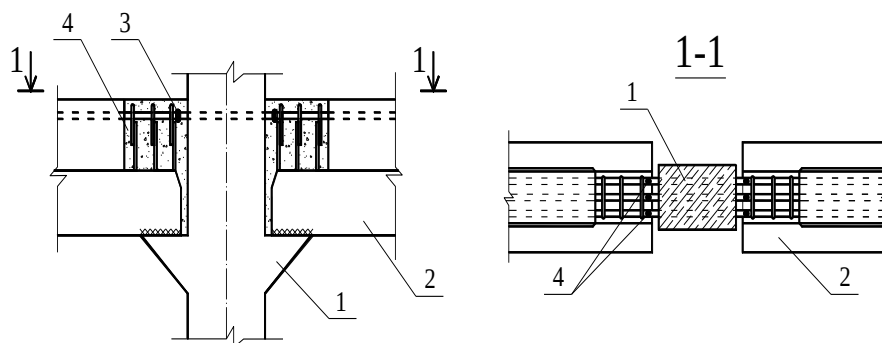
Сопряжение сборных поперечных ригелей перекрытия с колонной: 1 – колонна; 2 – ригель; 3 – ванная сварка; 4 – бетон замоноличивания.
